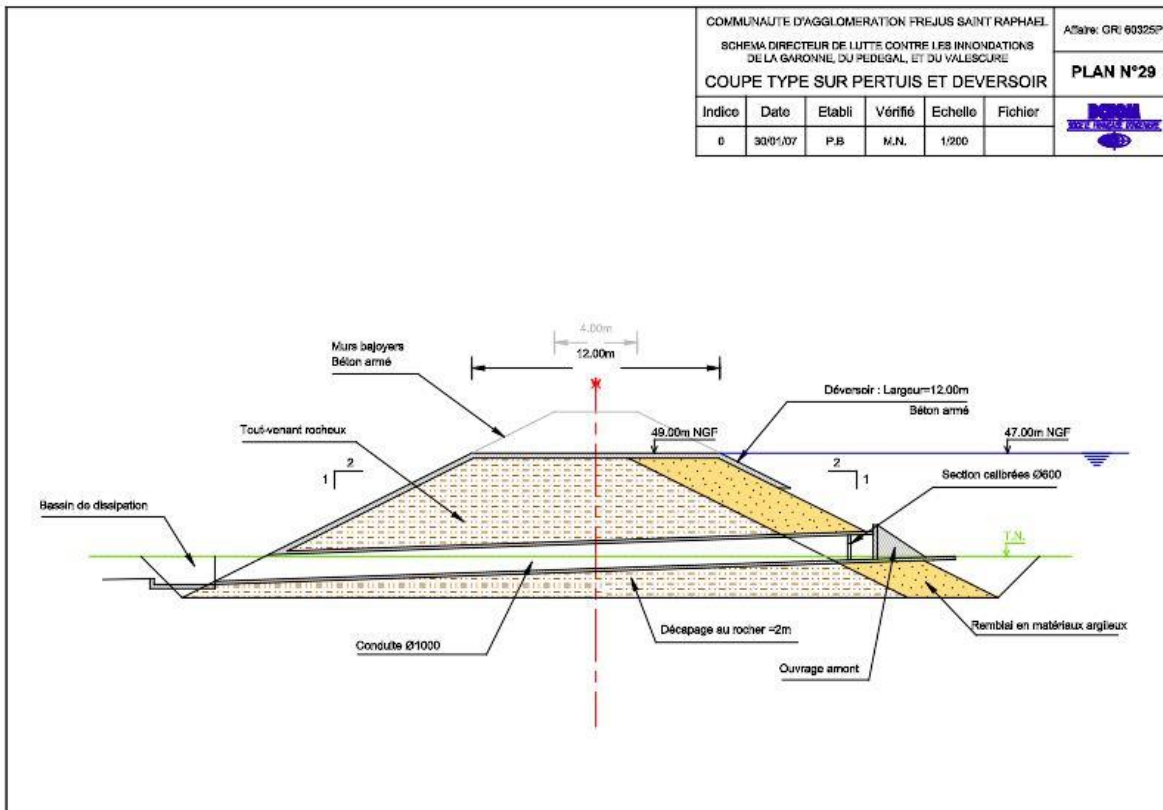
Plan en coupe au niveau du pertuis et du déversoir (Source : CAVEM)
